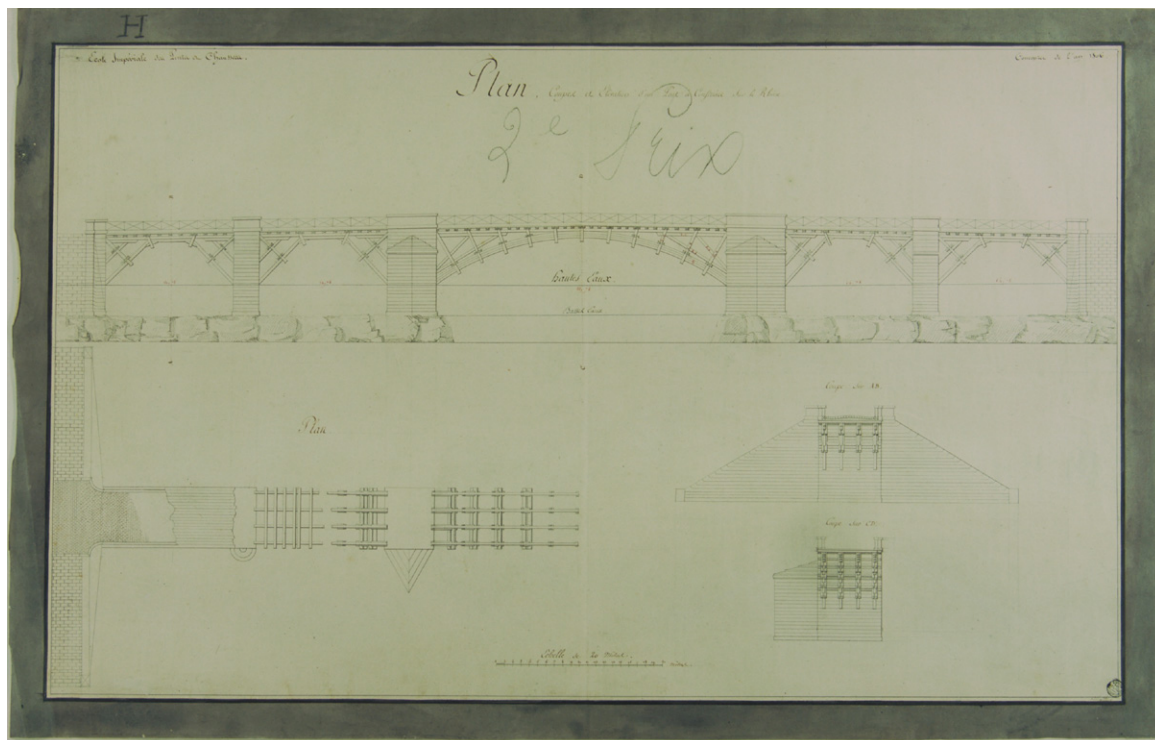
Pianta sezione e prospetto di un ponte da costruire sul Rodano. *2^e prix de pont en bois ou charpente.
